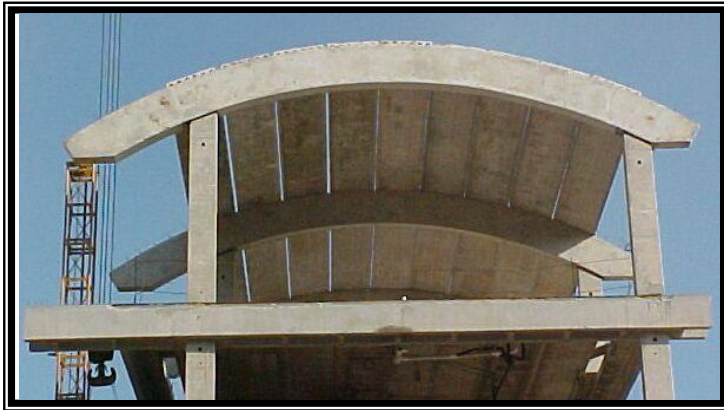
Empleo de losa Spiroll como elemento de Cubierta
